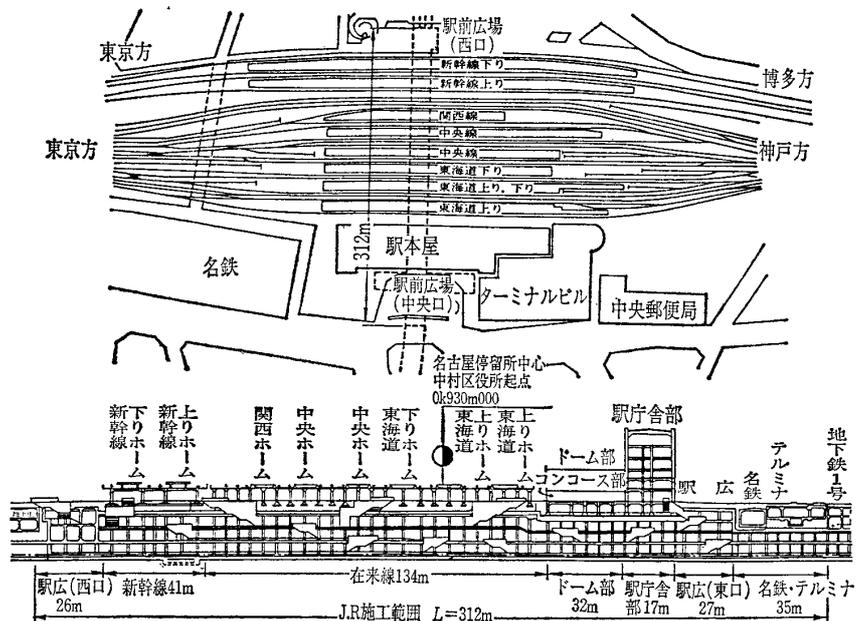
地下鉄 6 号線名古屋駅付近平面・縦断面図
